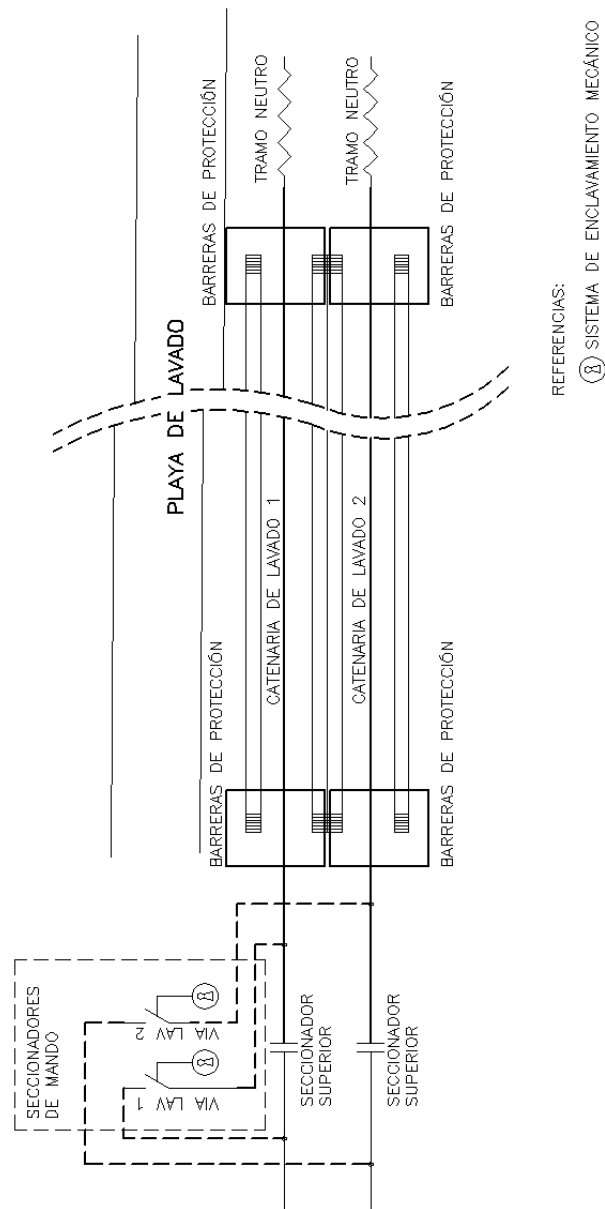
Conexionado de seccionadores Playa de lavado.
